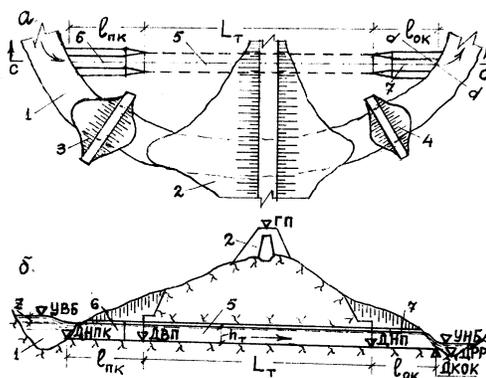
Водохранилищный гидроузел со строительным водосбросом:
